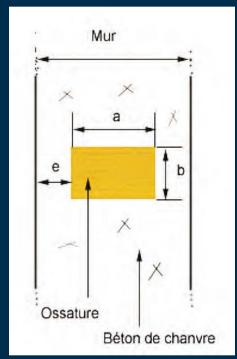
Coupe horizontale du mur ; épaisseur d'enrobage (e) et section de bois (a et b)
